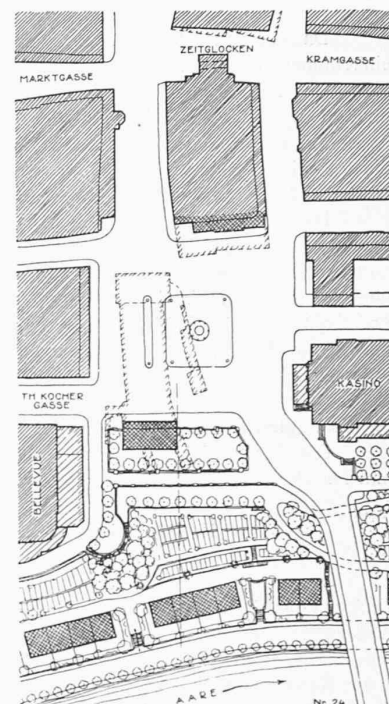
Lageplan 1:2500 zu Nr. 24.
